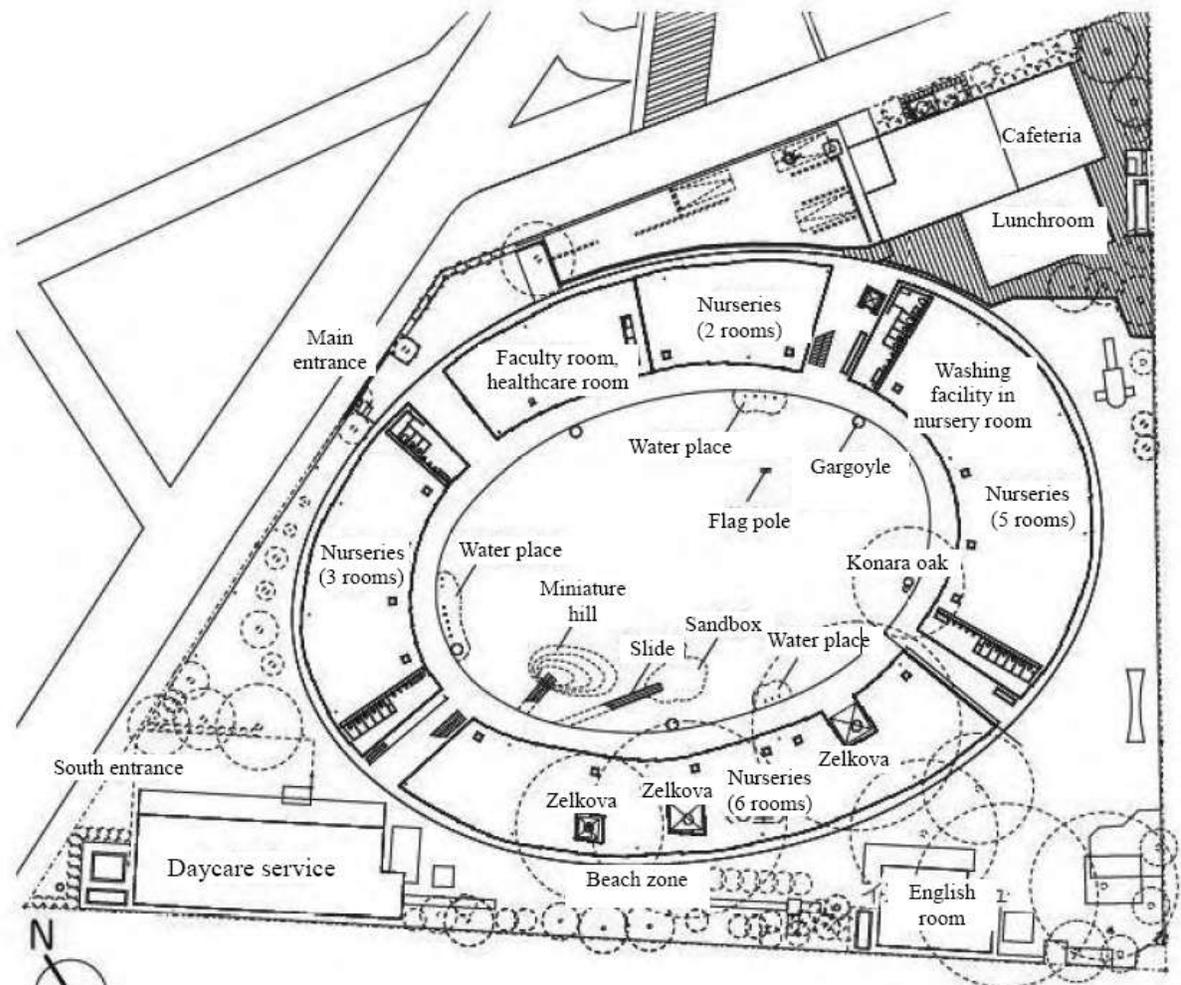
Planta baja del edificio del Fuji Kindergarten.
